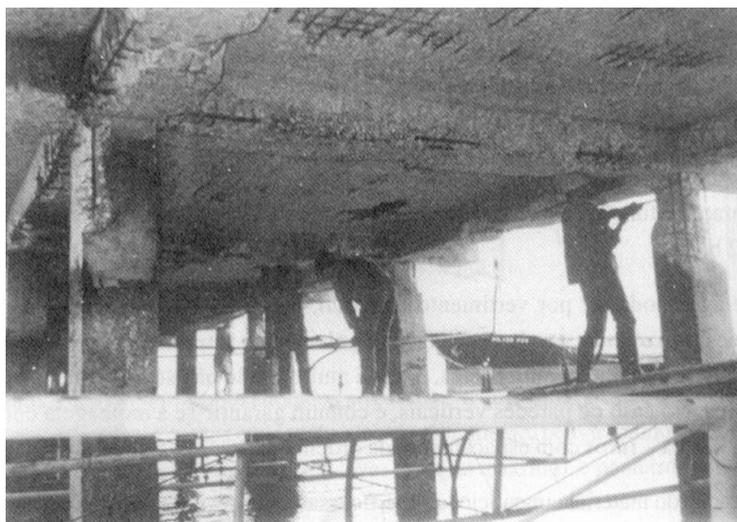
Remoção de concreto por corte (Souza e Ripper, 1998)
